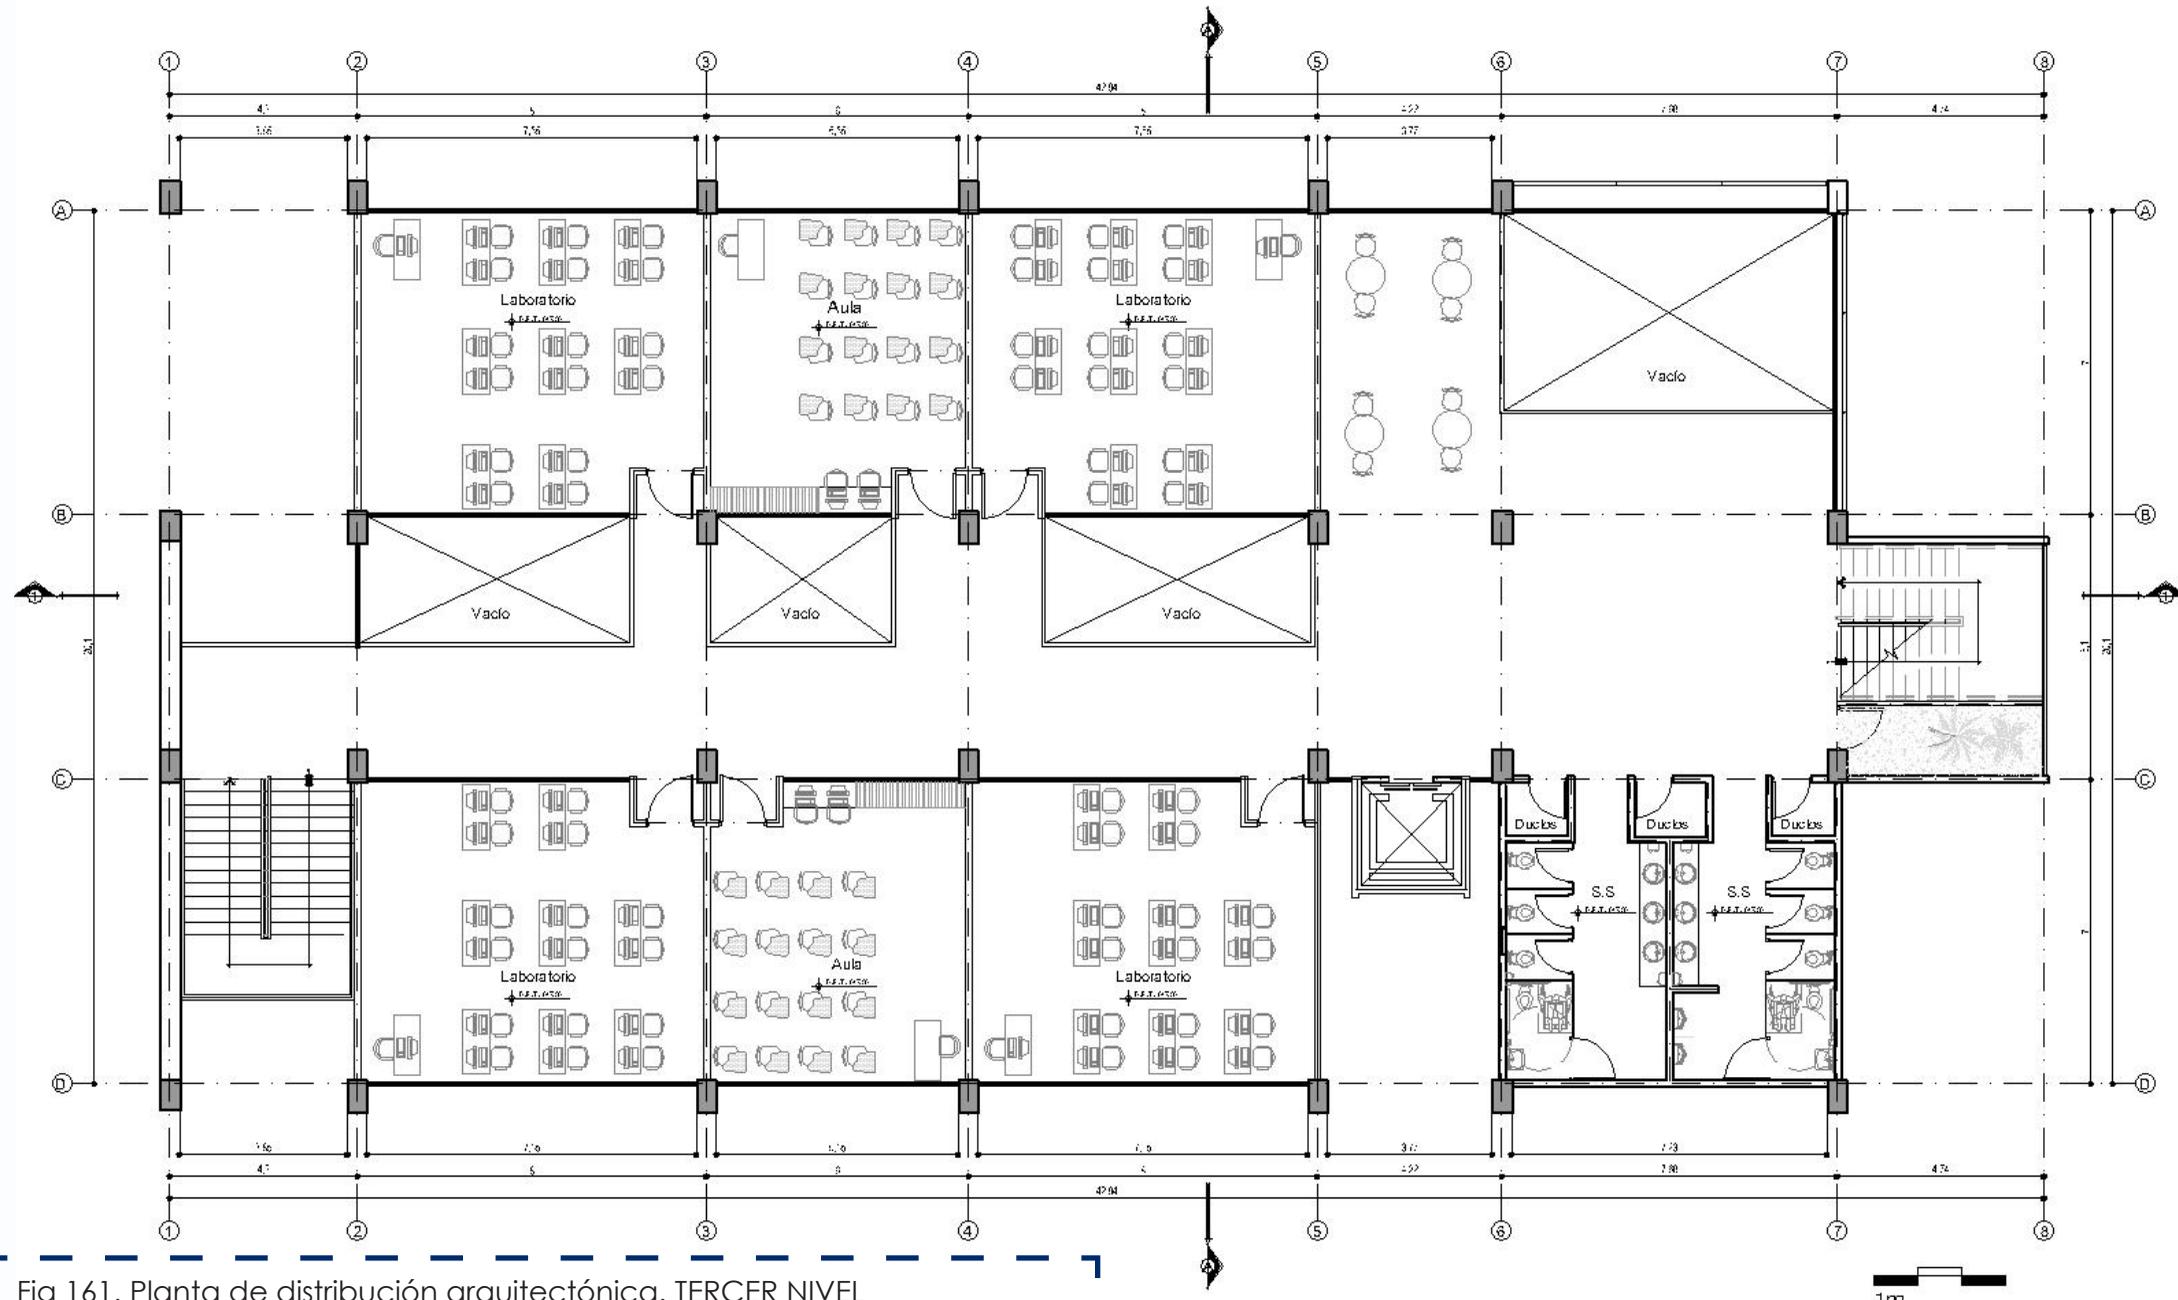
Planta de distribución arquitectónica. TERCER NIVEL
